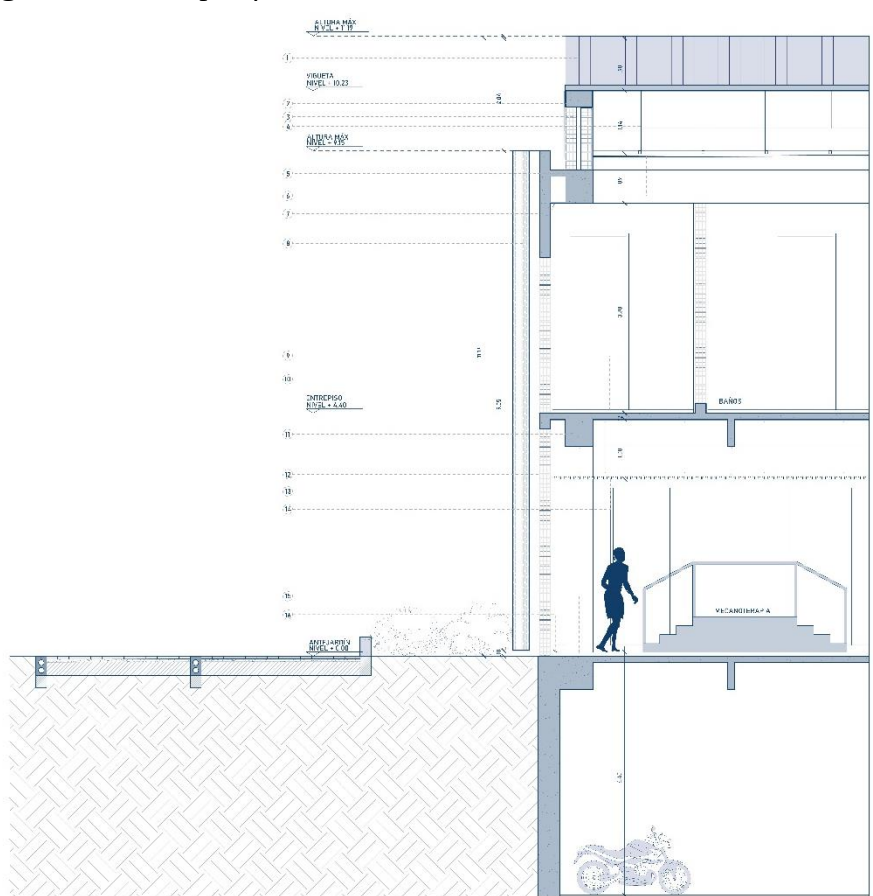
Sistema estructural primer y segundo piso en plantaFigura 45. Corte por fachada
